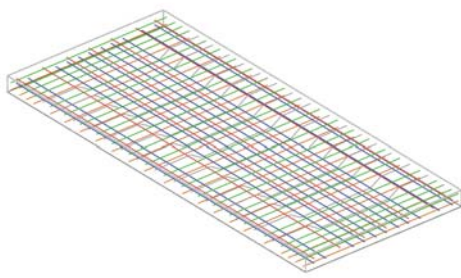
全体解析モデル図 (埋め込み鉄筋要素配置図)
